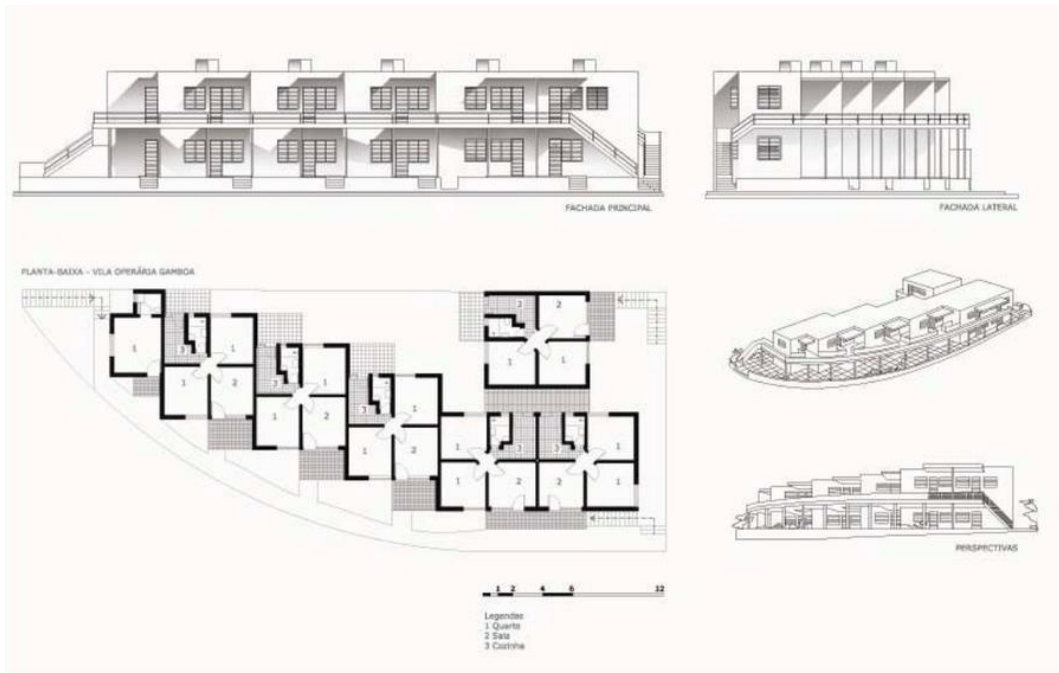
PLANTAS - Vila Operária da Gamboa, 1933 – Rio de Janeiro.
